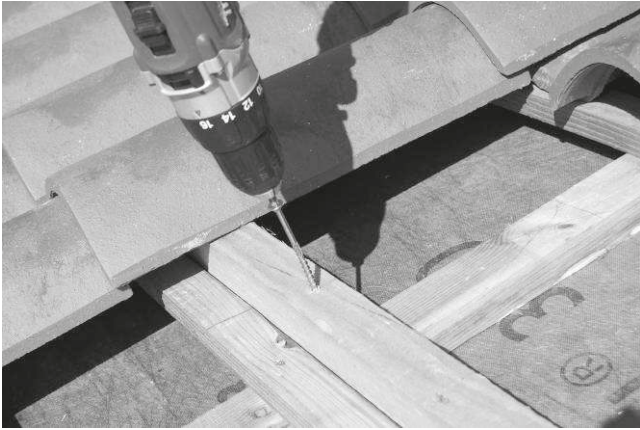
En partie haute, fixez un liteau de basculement pour la première rangée de tuiles supérieures au kit InterPV. Sa hauteur doit être de 54 mm minimum (double liteau) et sa longueur est celle d'un assemblage de rail.
